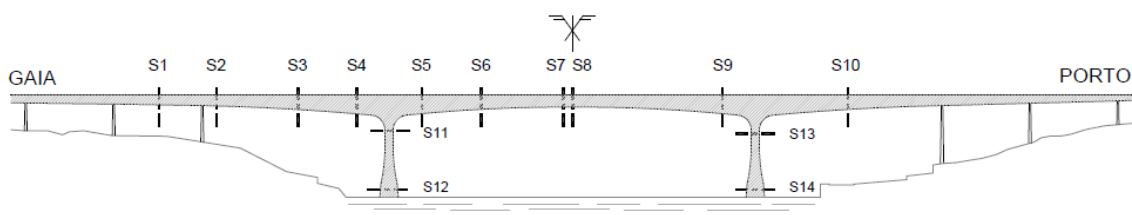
Localização das secções instrumentadas (Santos, 2001).
